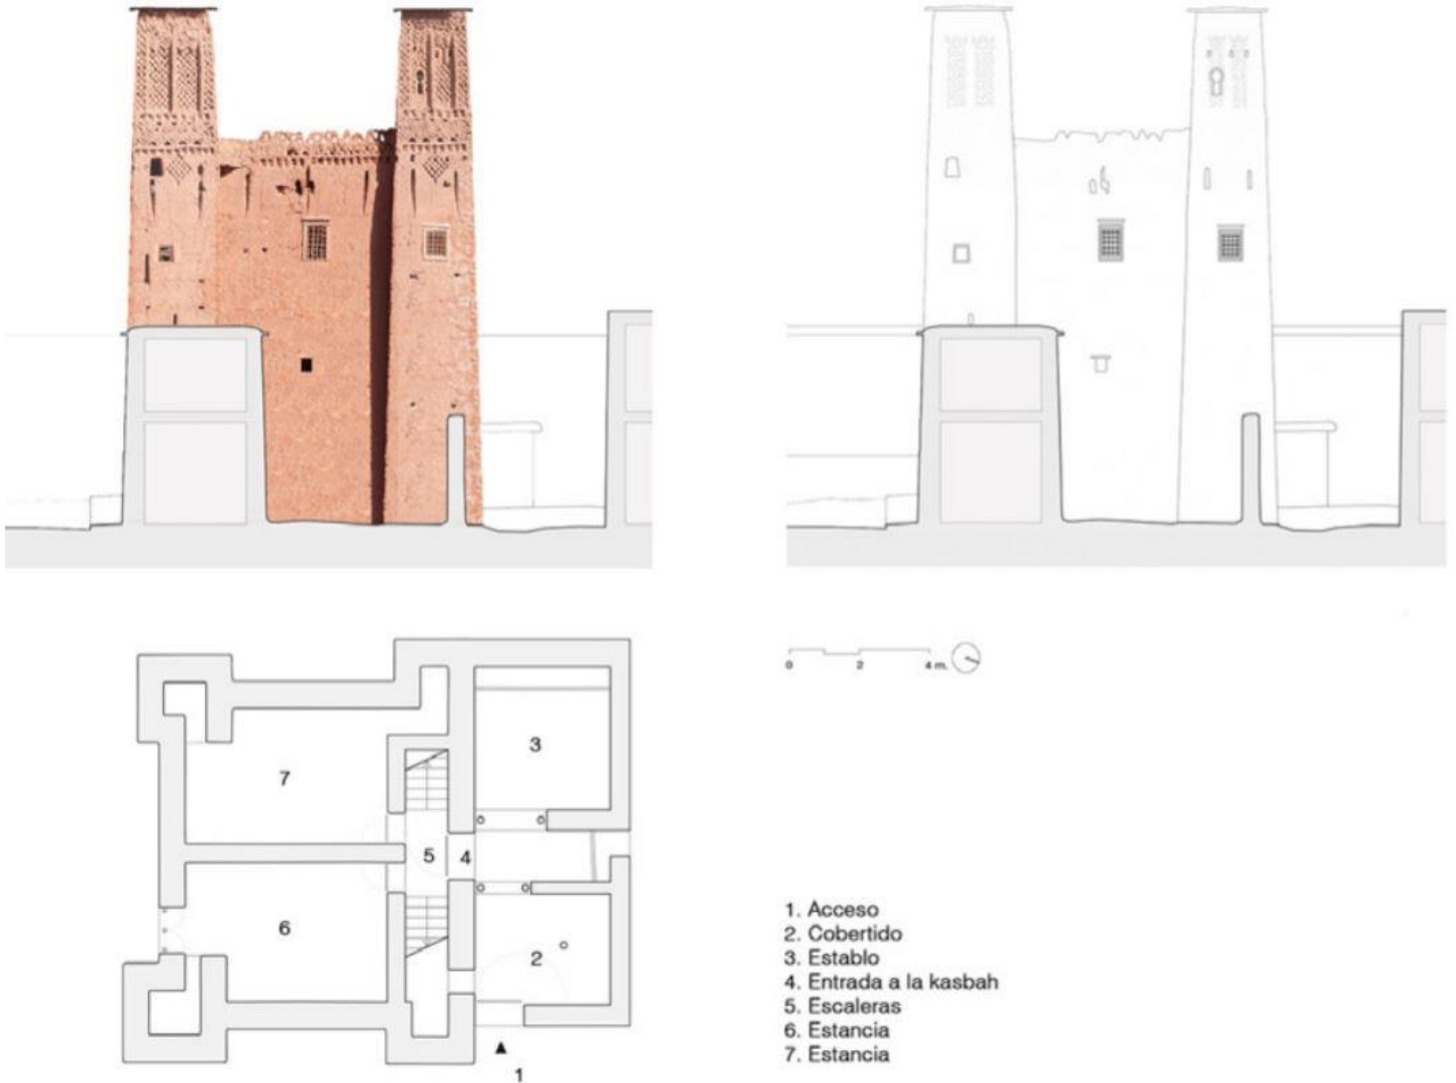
planta y alzados de kasbah Ait Aicha-Marruecos
